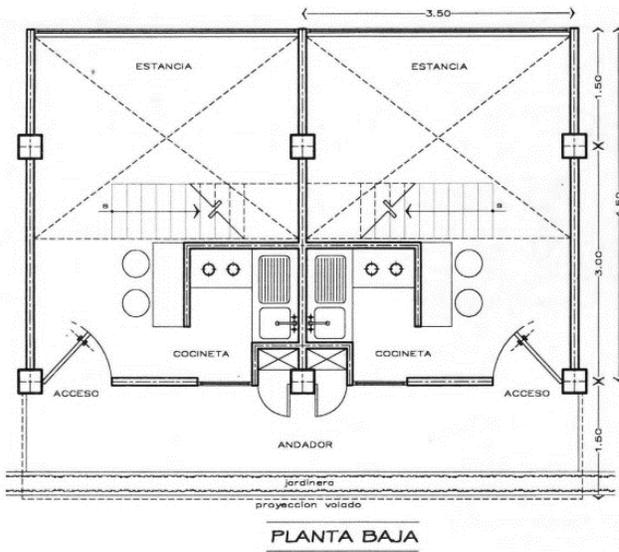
Proyecto de la ciudad obrera de México (Planta Tipo).
